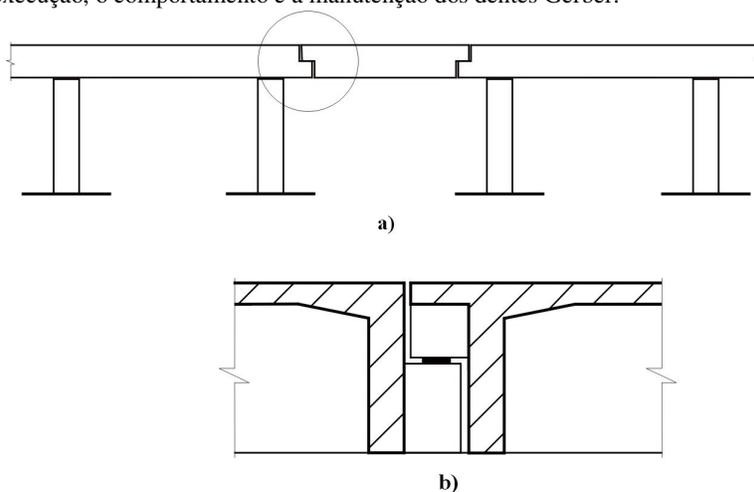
Ponte em viga Gerber: a) esquema longitudinal; b) detalhe do dente Gerber
